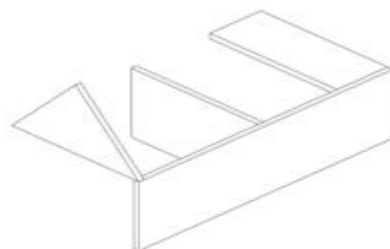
Exemples de contreventement par panneaux et par triangulation
